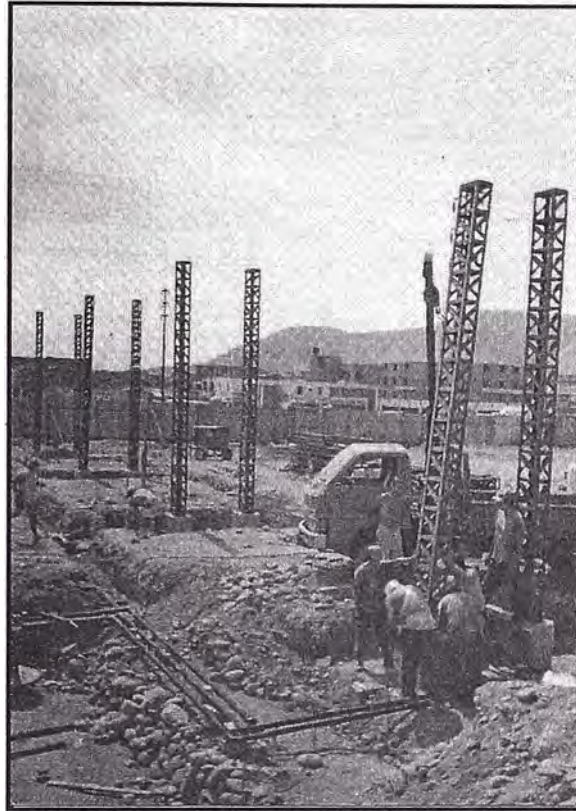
Se comenzó a colocar los pilares de fierro reticulado del Canopy en cada una de las zapatas con la ayuda de un camión grúa. Además las tuberías llegaron en cada en las zonas donde se colocaran los dispensadores de combustible.
